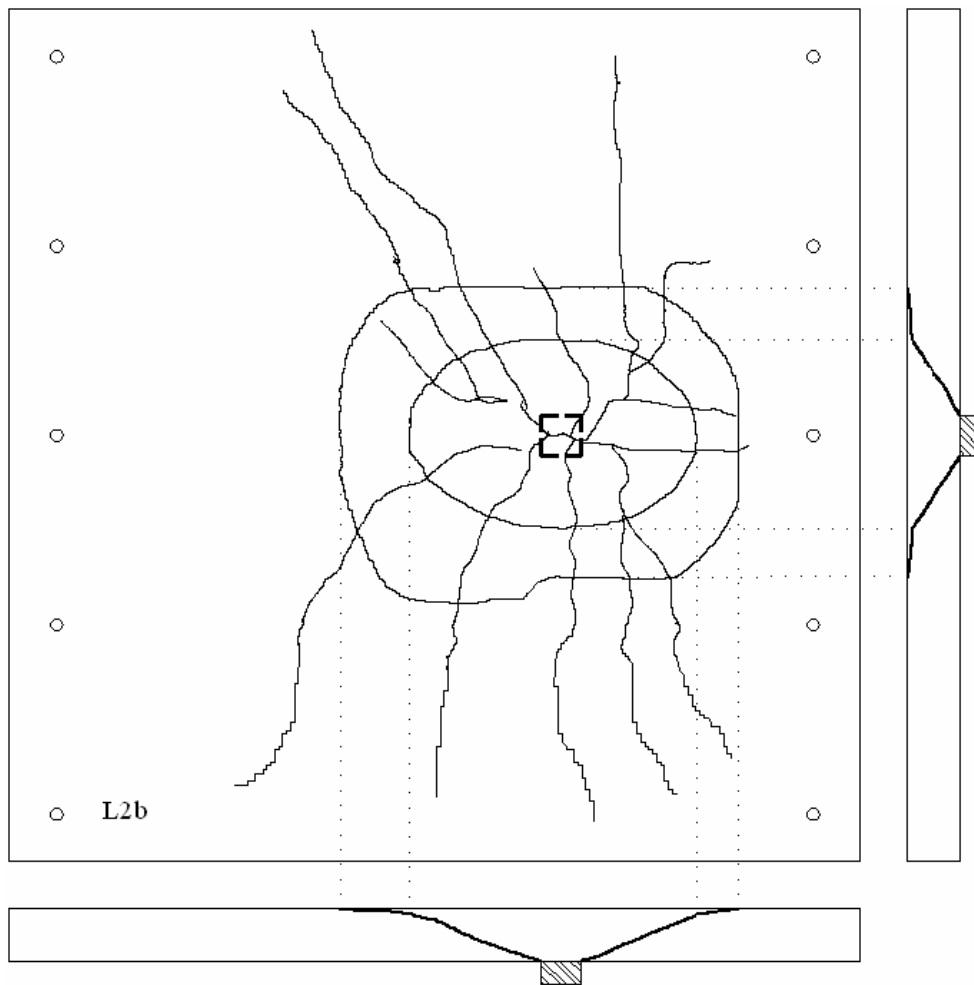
Mapa de fissuração da laje L2b
